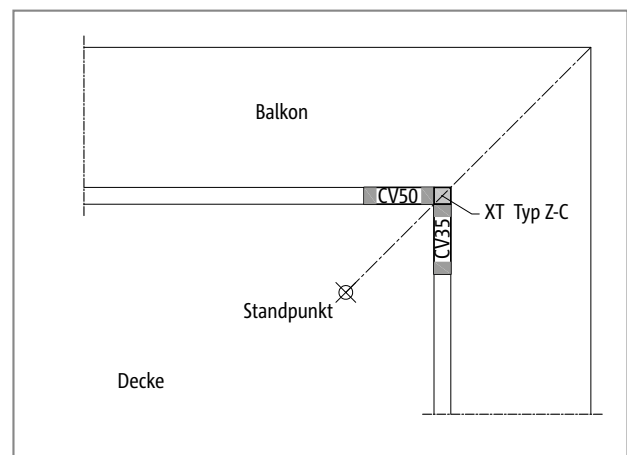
Schöck Isokorb® XT Typ C: Betondeckung wählbar: Hier CV50 links vom Standpunkt, Betondeckung CV35 rechts vom Standpunkt
